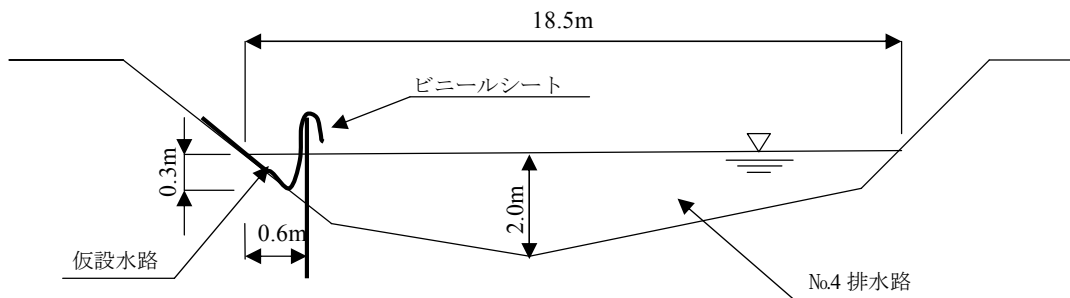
Drain No.4 排水路と仮設水路の断面
